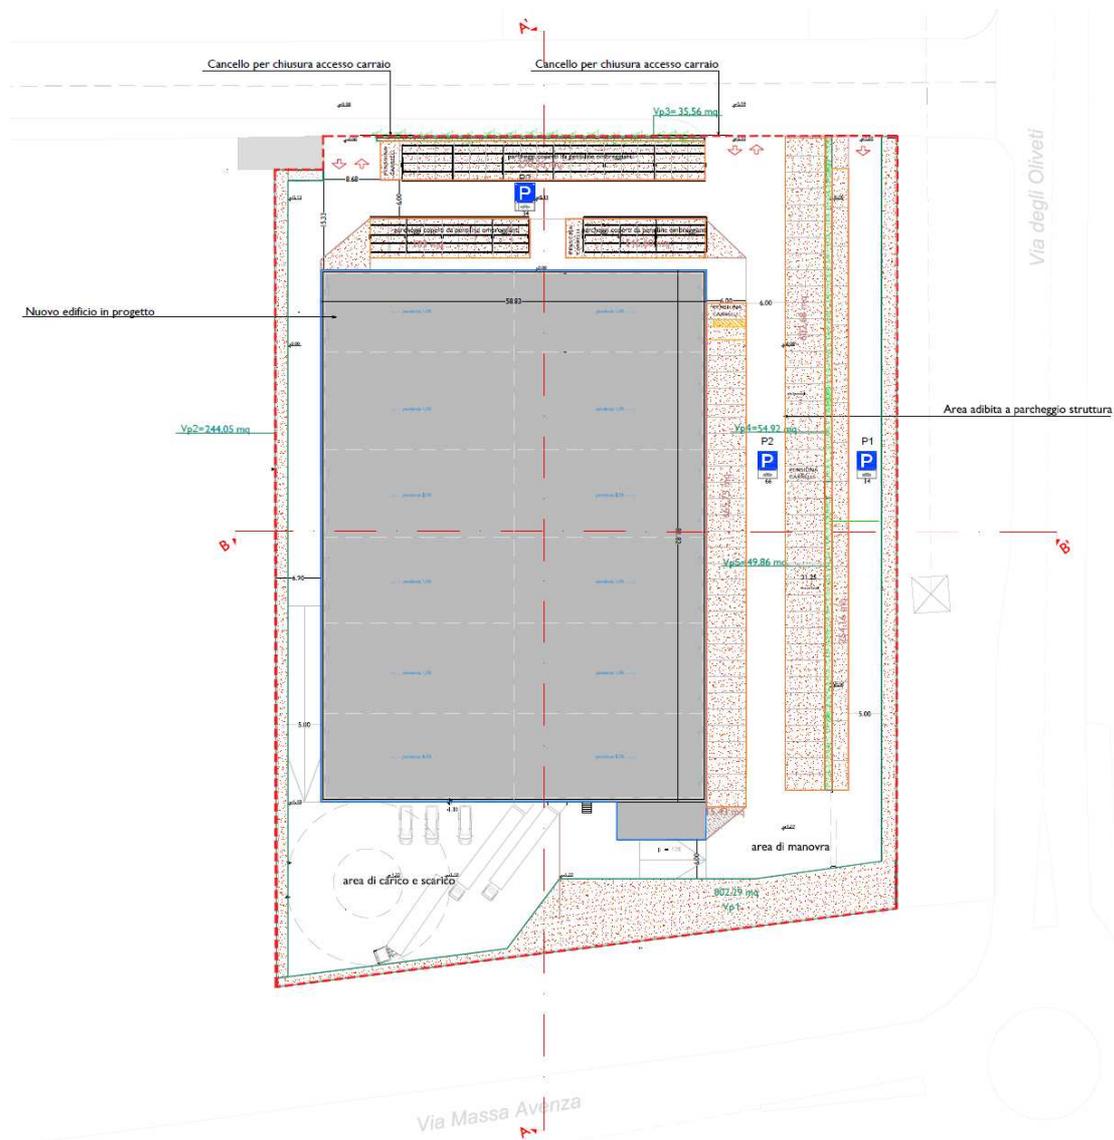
stralcio Tavola 5 Planimetria di inserimento a progetto
